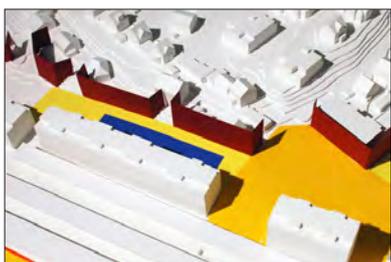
Bahnhof Nord: Haltestelle GTB in Überlandstrasse, Verdichtung und Aufwertung Aussenraum
